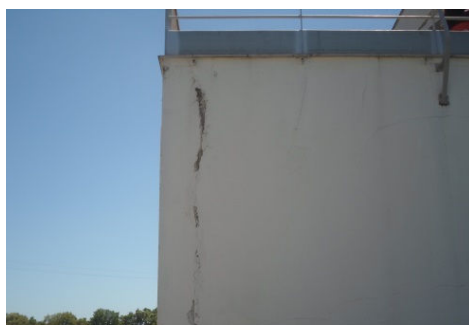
Fissuras no revestimento em isolamento térmico pelo exterior
